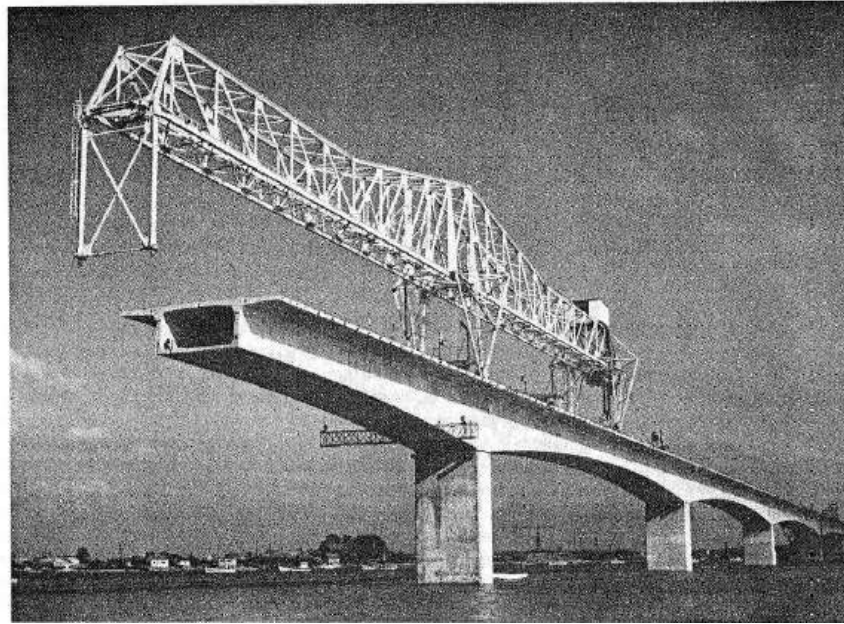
Puente Oleron, viga metálica desplazable para la colocación de las dovelas prefabricadas en su traslado al pilar siguiente.
